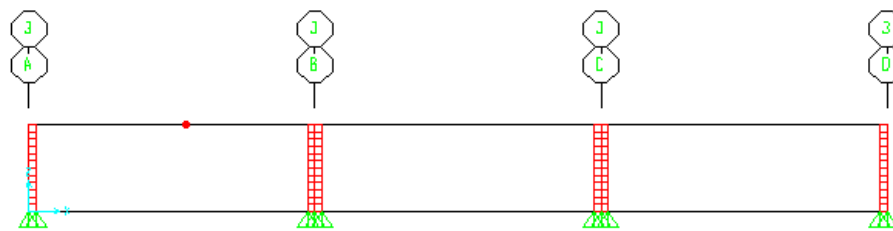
Laje Lisa sobre apoios sólidos – Vista XZ
